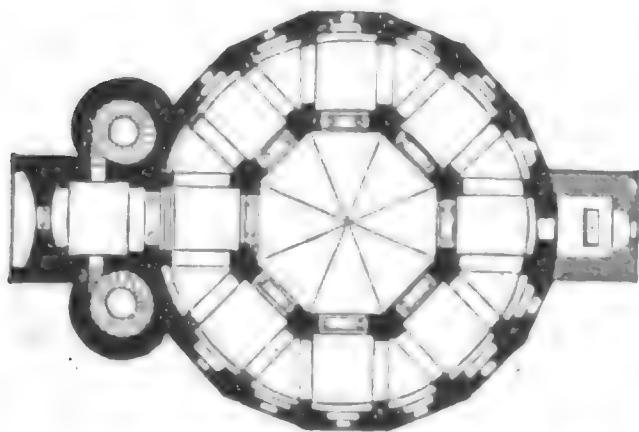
Grundriß der Pfalzkapelle zu Aachen.
